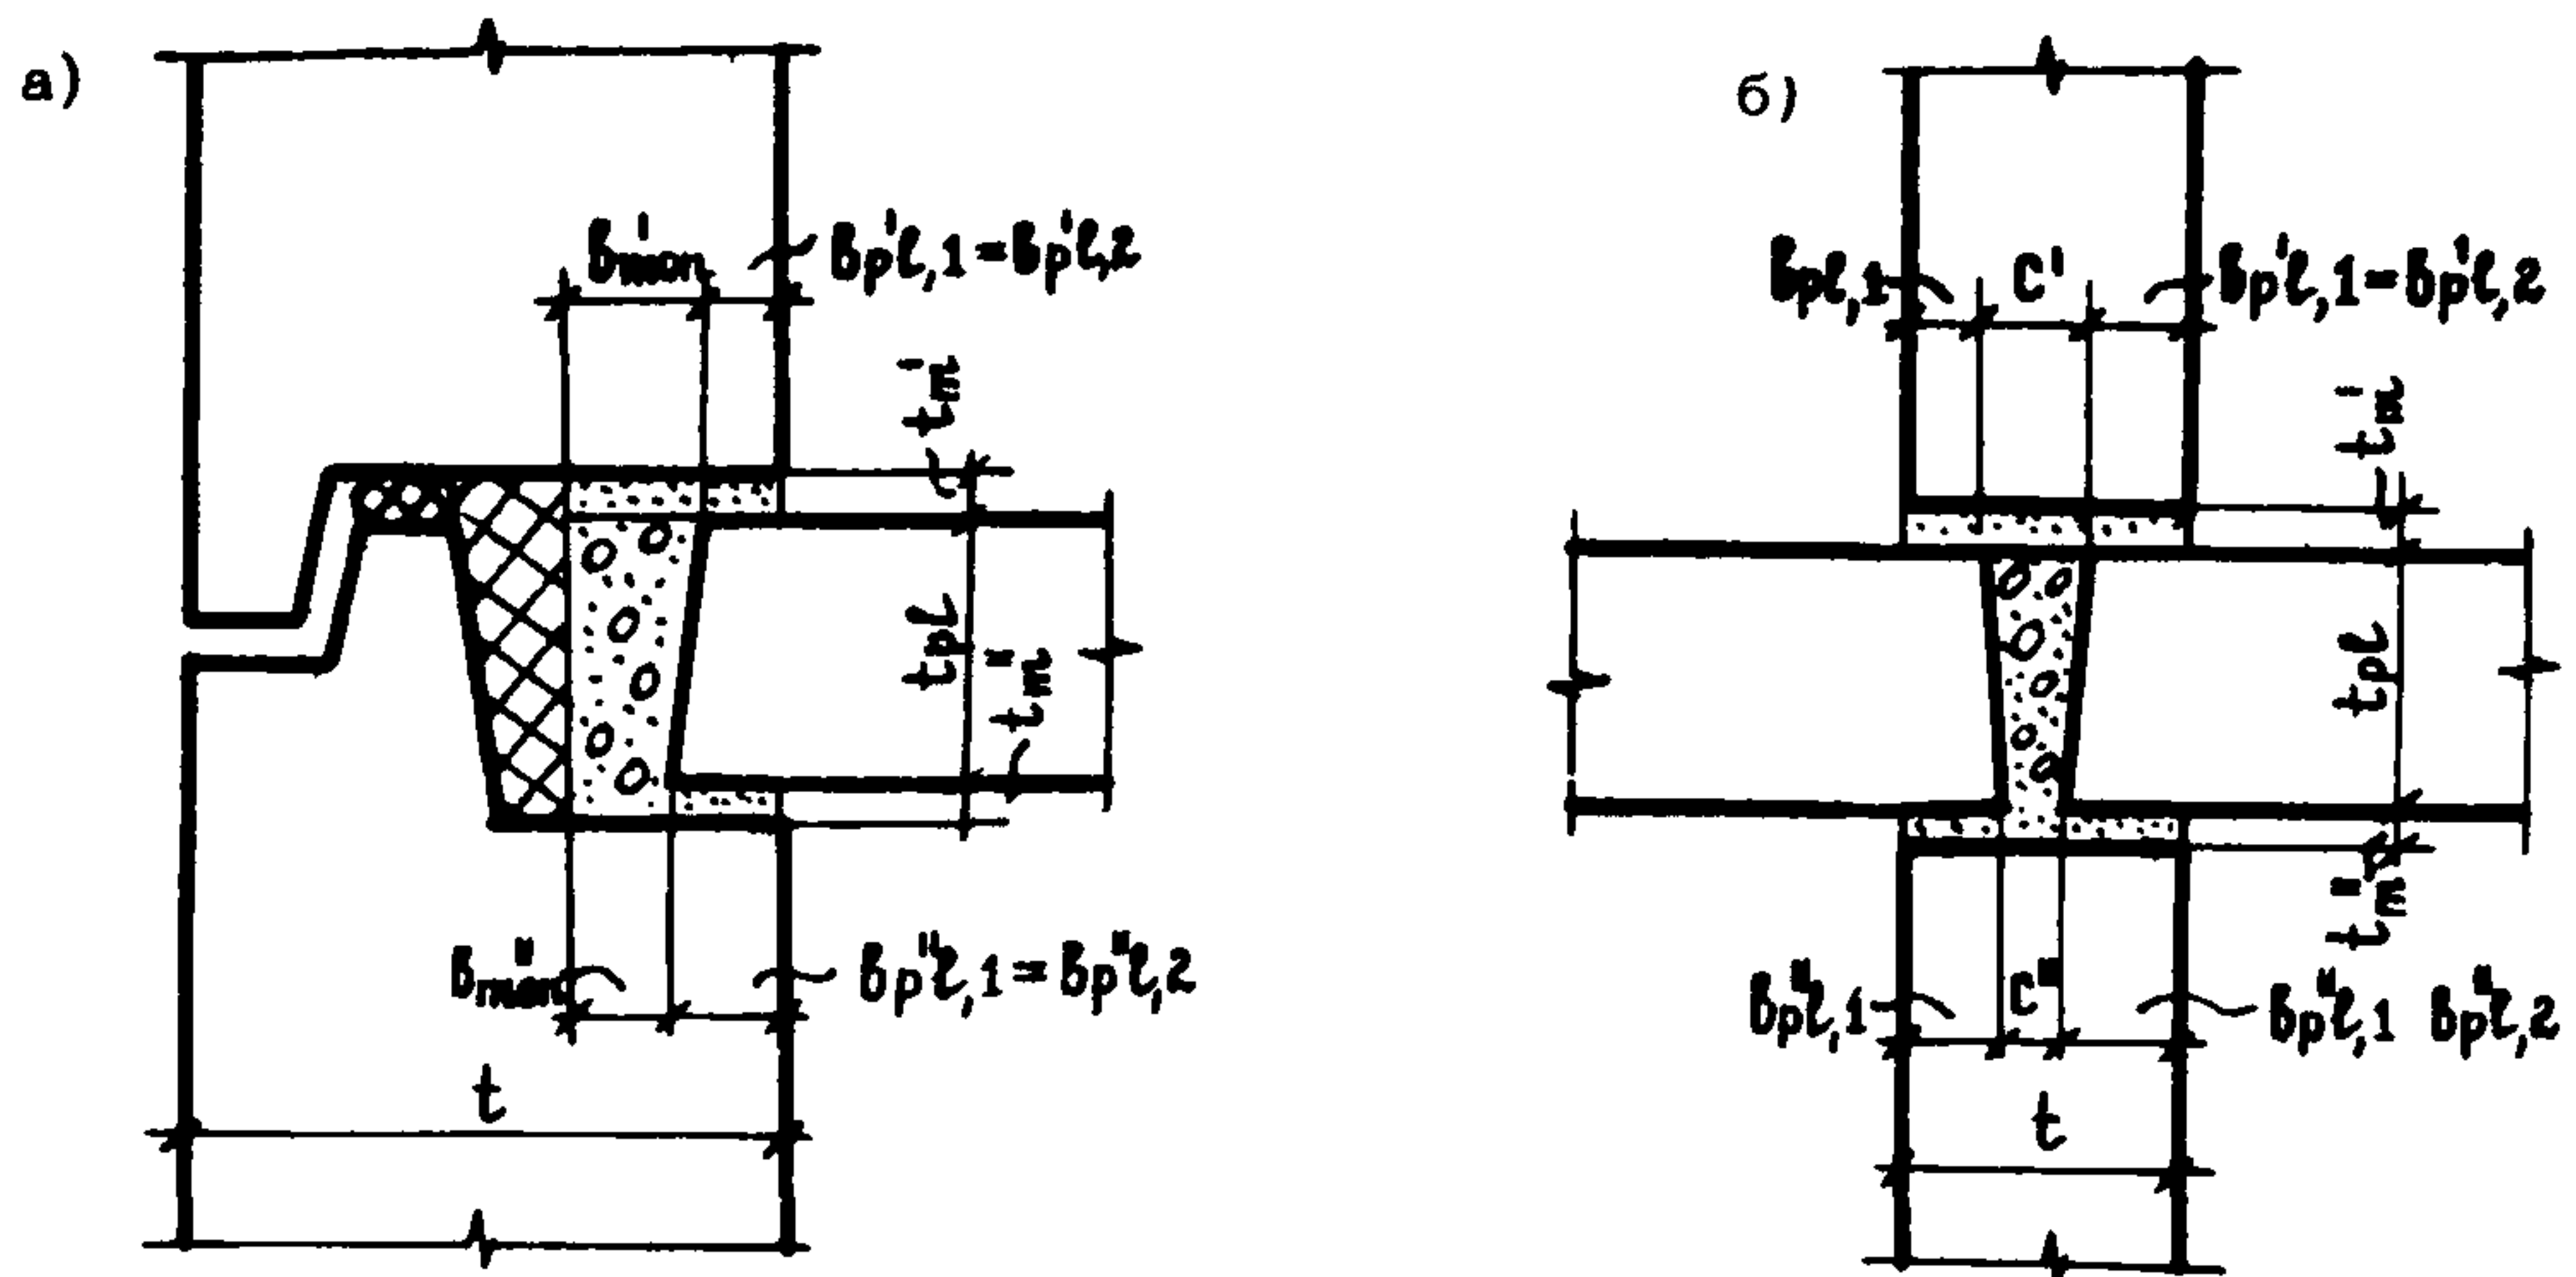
Платформенно-монолитные стыки с односторонним (а) и двусторонним (б) опиранием плит перекрытий
